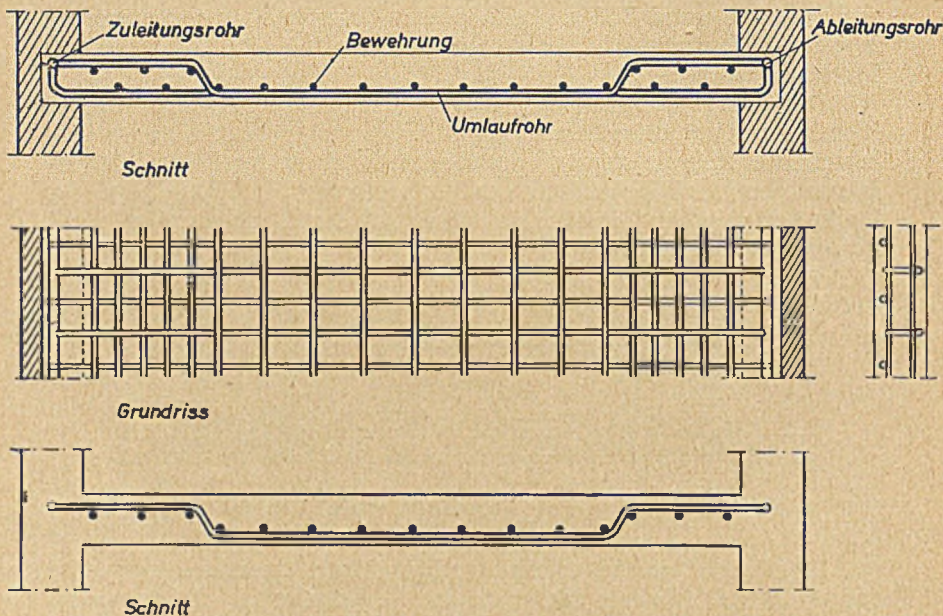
Decken- und Wandheizungsanlage nach dem DRP. 655846
